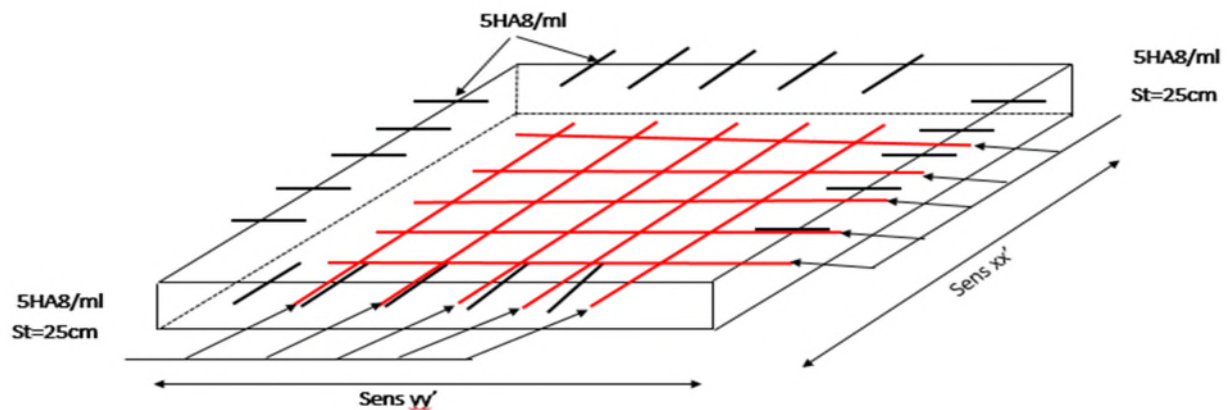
Schéma de ferrailage de la dalle pleine au-dessous
